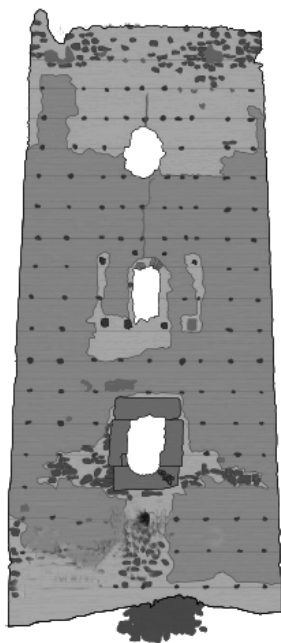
Alzado de la Torre Alèdua según Pilar Barambio<sup>421</sup>
